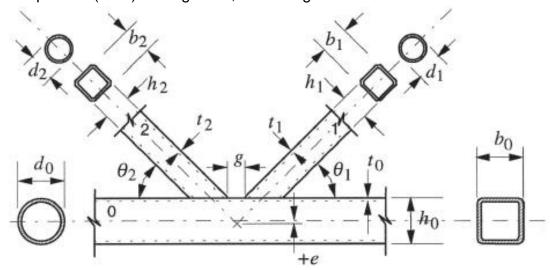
Hohlprofil K-Knoten mit Spalt [39]
